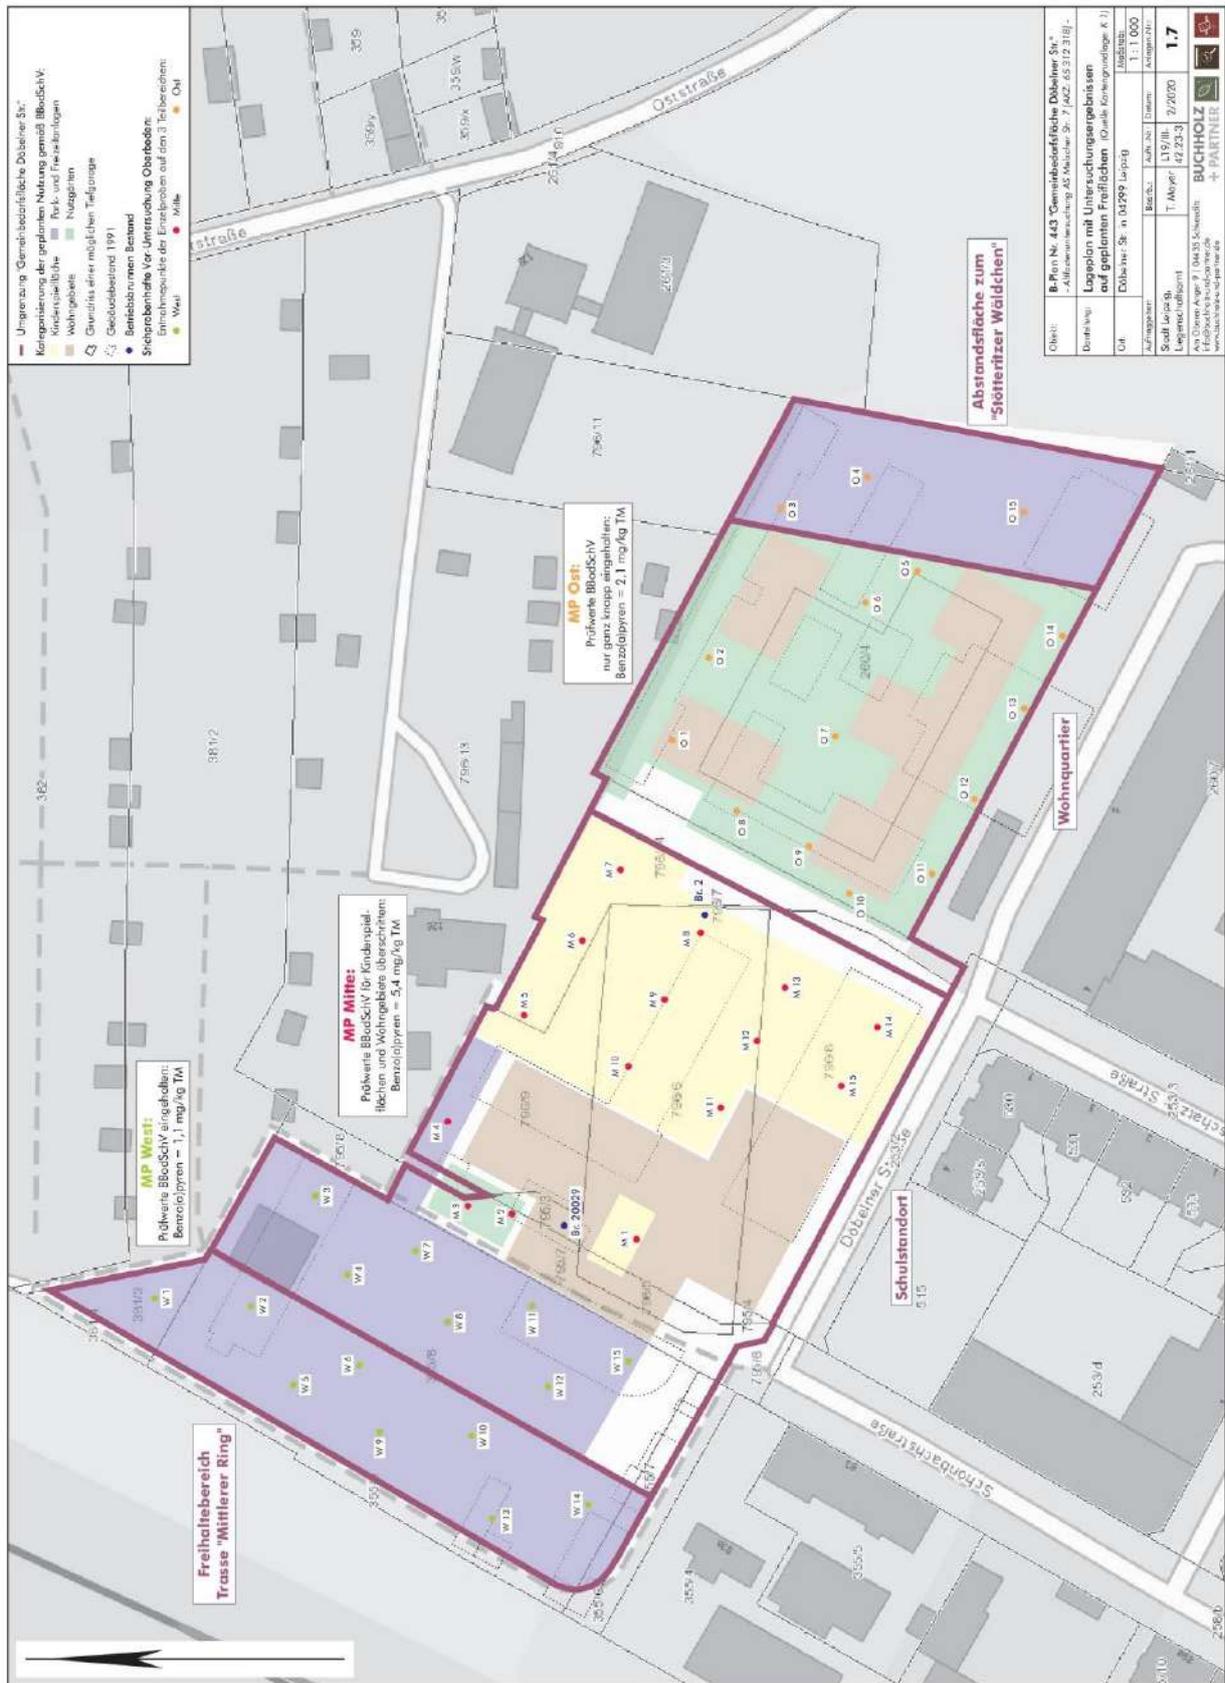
Lageplan mit Untersuchungsergebnissen auf geplanten Freiflächen
